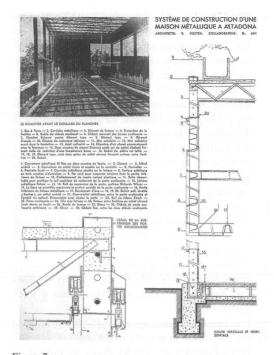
Vivienda unifamiliar con estructura metálica. Detalles constructivos (Archivo Histórico COAM GM/CP015/C1-06)
